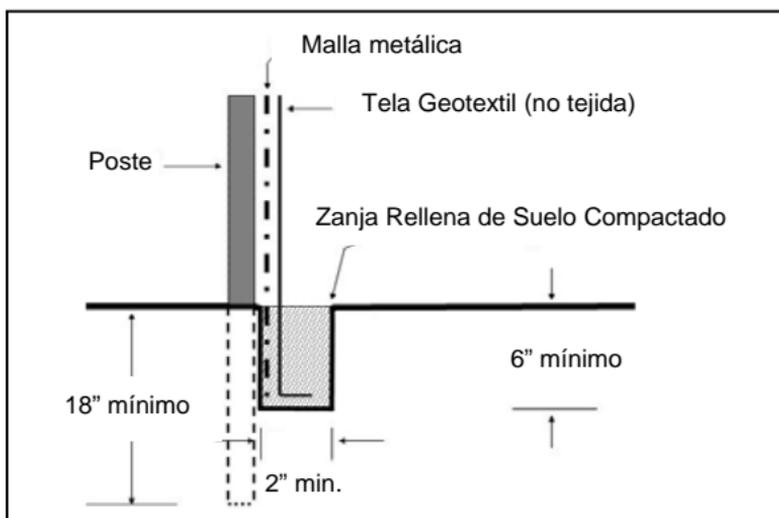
Detalles para la instalación de barreras de cieno Tipo A y B.
